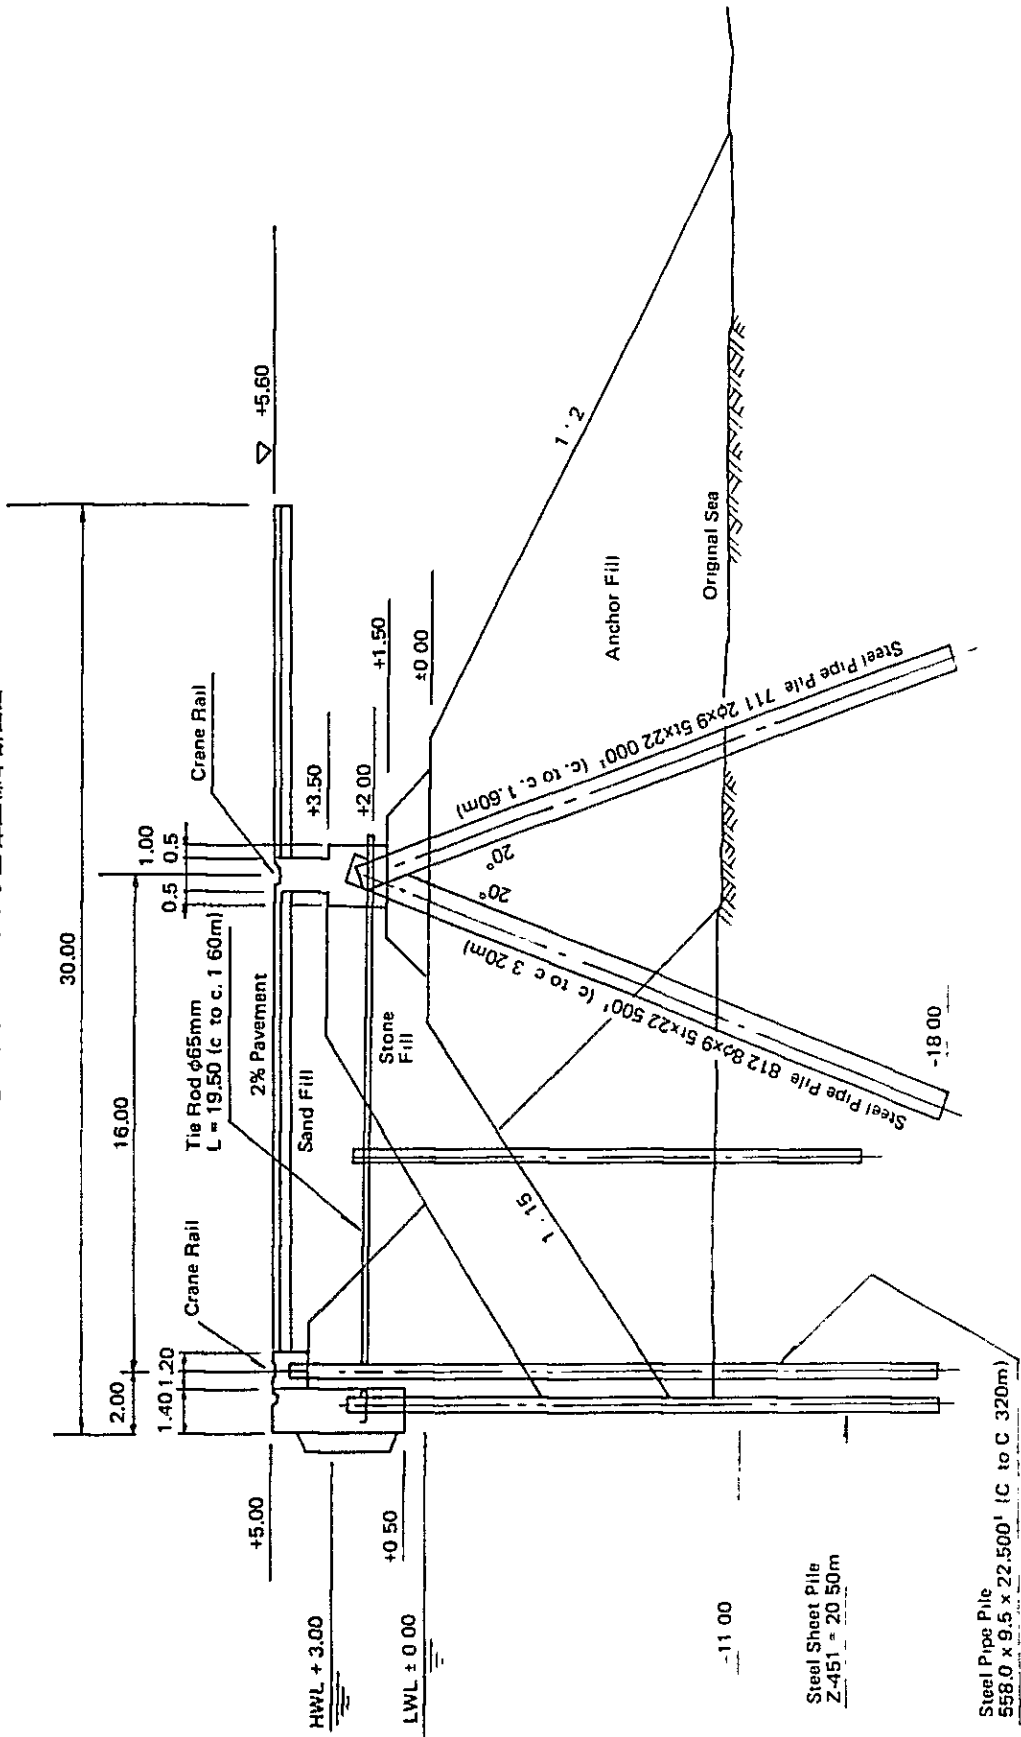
(2) 110 m 岸壁 (棚構造部) 標準断面图
